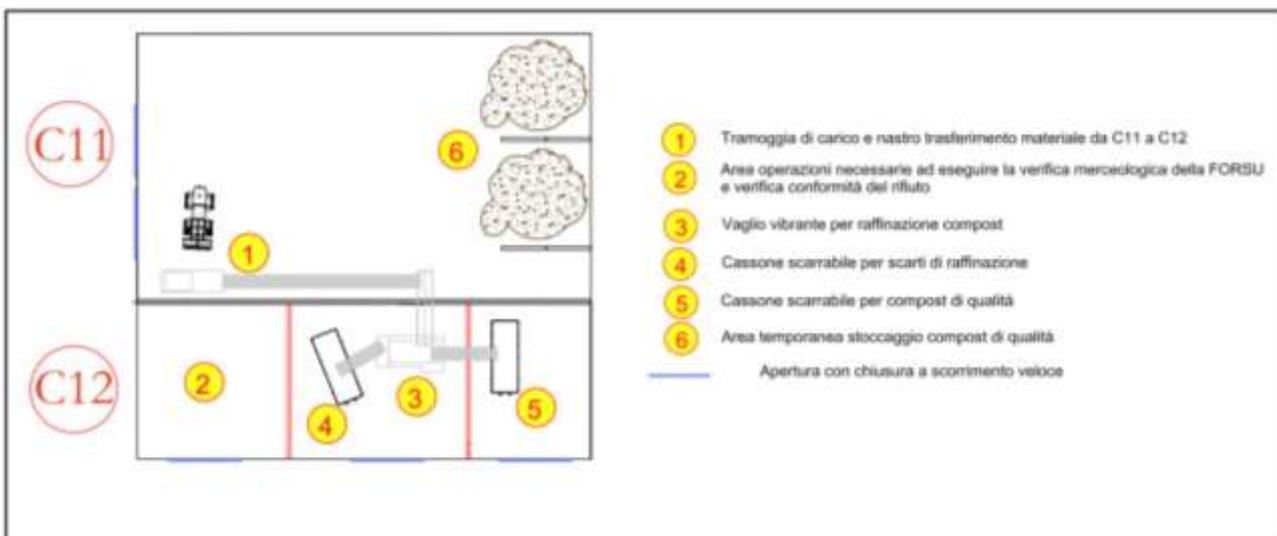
PLANIMETRIA CAPANNONE C11 E C12 – LAYOUT MODIFICATO
